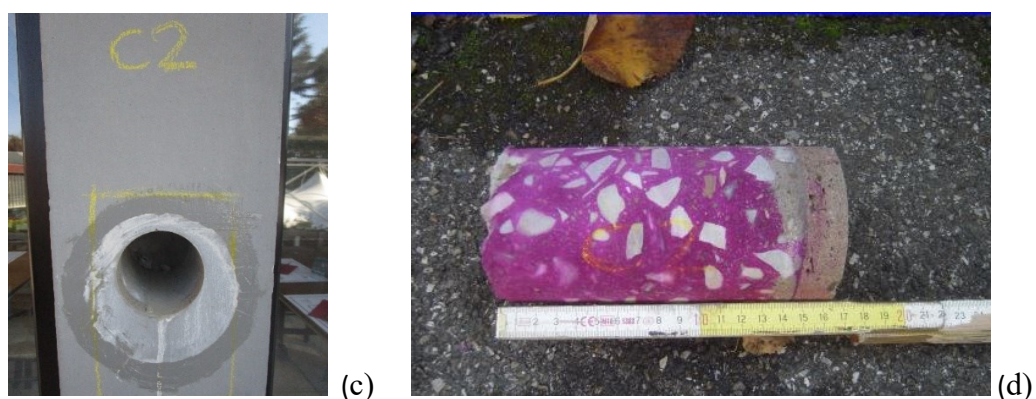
Carotaggio su un pilastro del primo piano individuato in pianta con cerchio verde (c); pigmentazione risultante dalle prove di carbonatazione effettuate con spray alla fenoltaleina (d)
